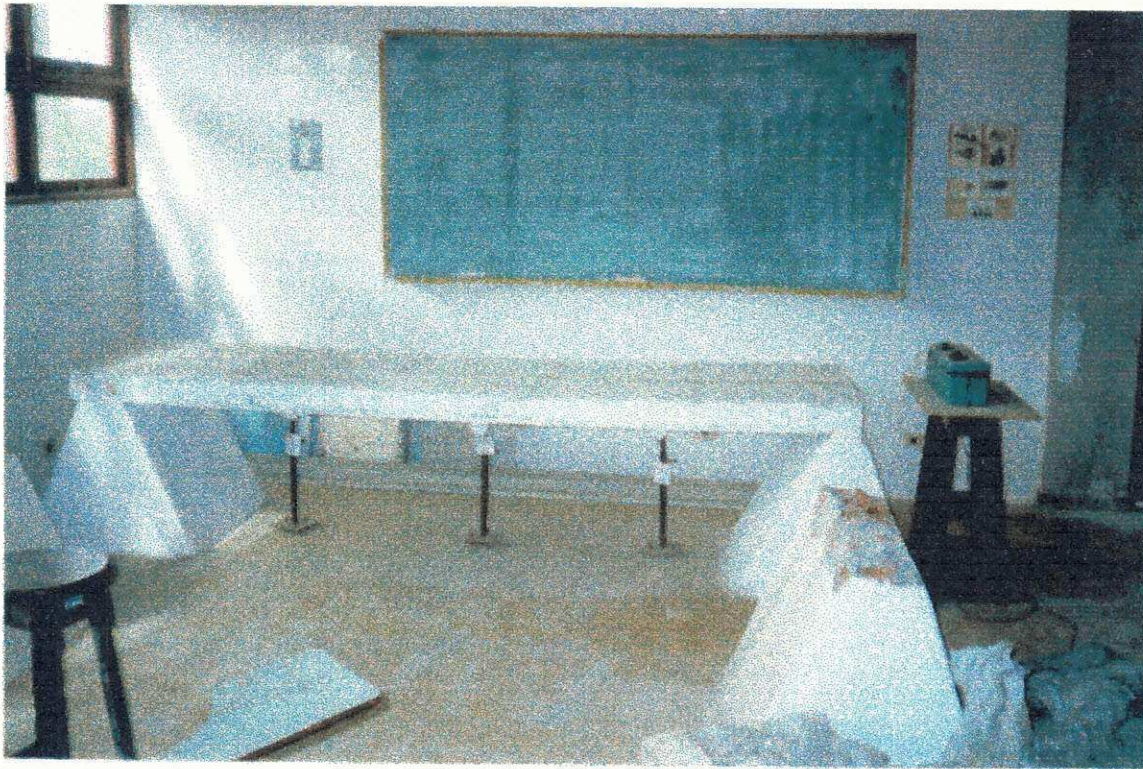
Capeamento das Lajes Pré-Moldadas
